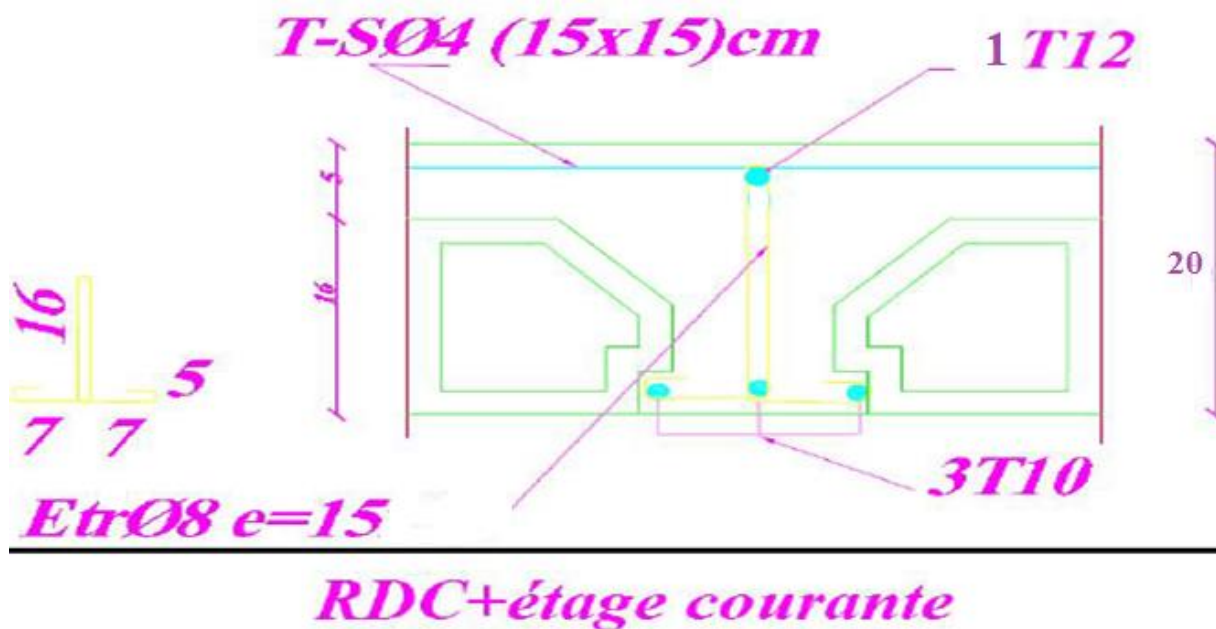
Disposition constructive des armatures dans la poutrelle (RDC+étage courante)
